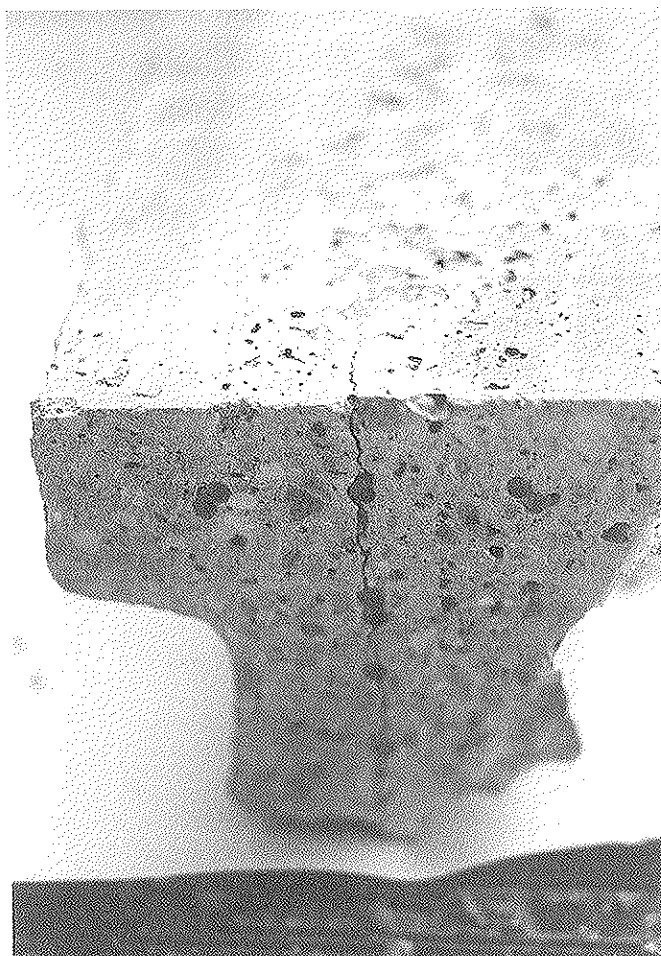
Vigueta de hormigón pretensado agrietada en la zona de transmisión de la fuerza de pretensado.
